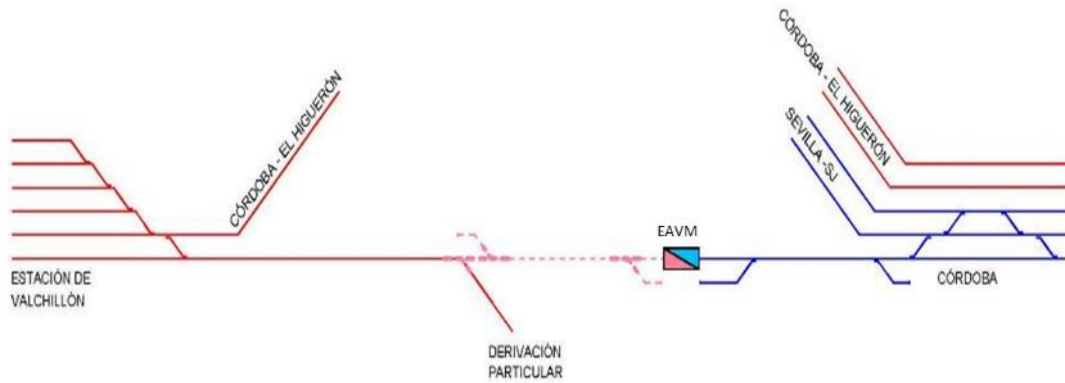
Posible esquema de vías para implantación de un cambiador EAVM
